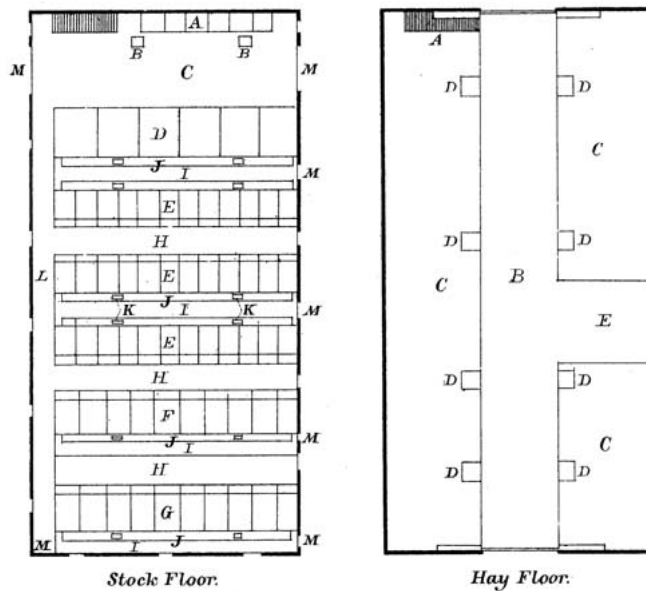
1871年のマサチューセッツ農科大学バーン2階平面図
